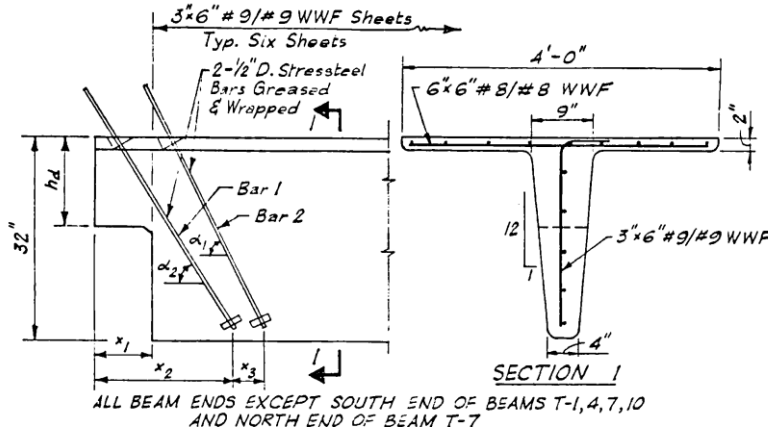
Detalle de geometría y pretensado de los apoyos ensayados por Hamoudi et al. [36]
